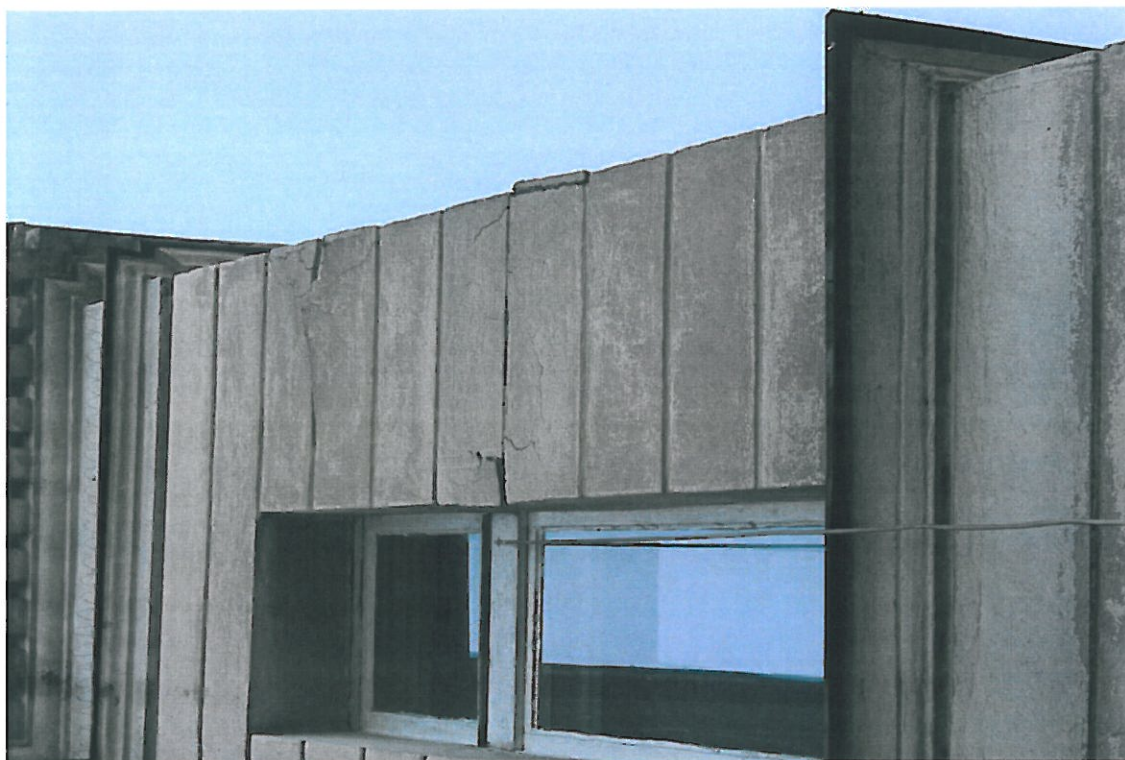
Elewacja frontowa – balkon – widok ogólny
